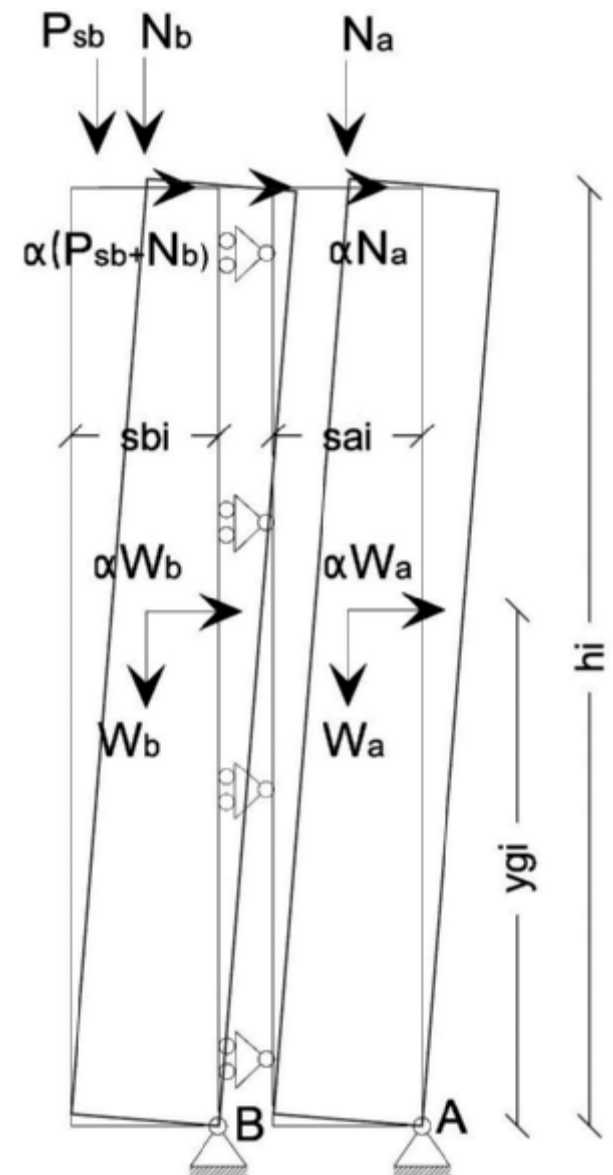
Schema di danno per la verifica a ribaltamento della porzione di parete su via Saffi. A vantaggio di sicurezza, si considerano pareti a doppia cortina. Sulla sola cortina interna gravano i carichi portati dalle aree d'influenza dei solai. Si impone una rotazione virtuale e si determinano gli spostamenti per ciascuna forza agente. Applicando il P.L.V. si ricava il moltiplicatore α delle forze orizzontali, significativo per il calcolo dell'accelerazione attesa su suolo di riferimento, da confrontarsi, ai fini della verifica, con l'accelerazione P_g , definita attraverso i parametri della pericolosità sismica di base.
